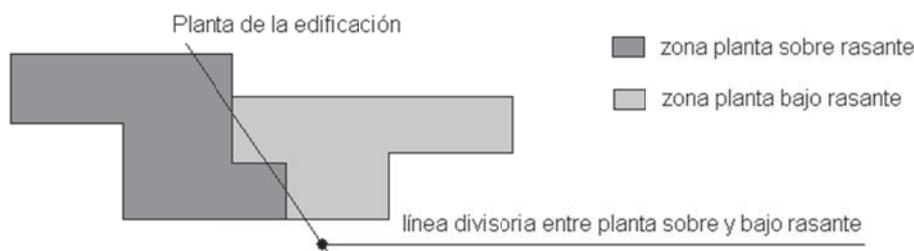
Reparto superficial equivalente siguiendo divisorias características de la edificación entre la zona considerada planta sobre rasante y planta bajo rasante.
